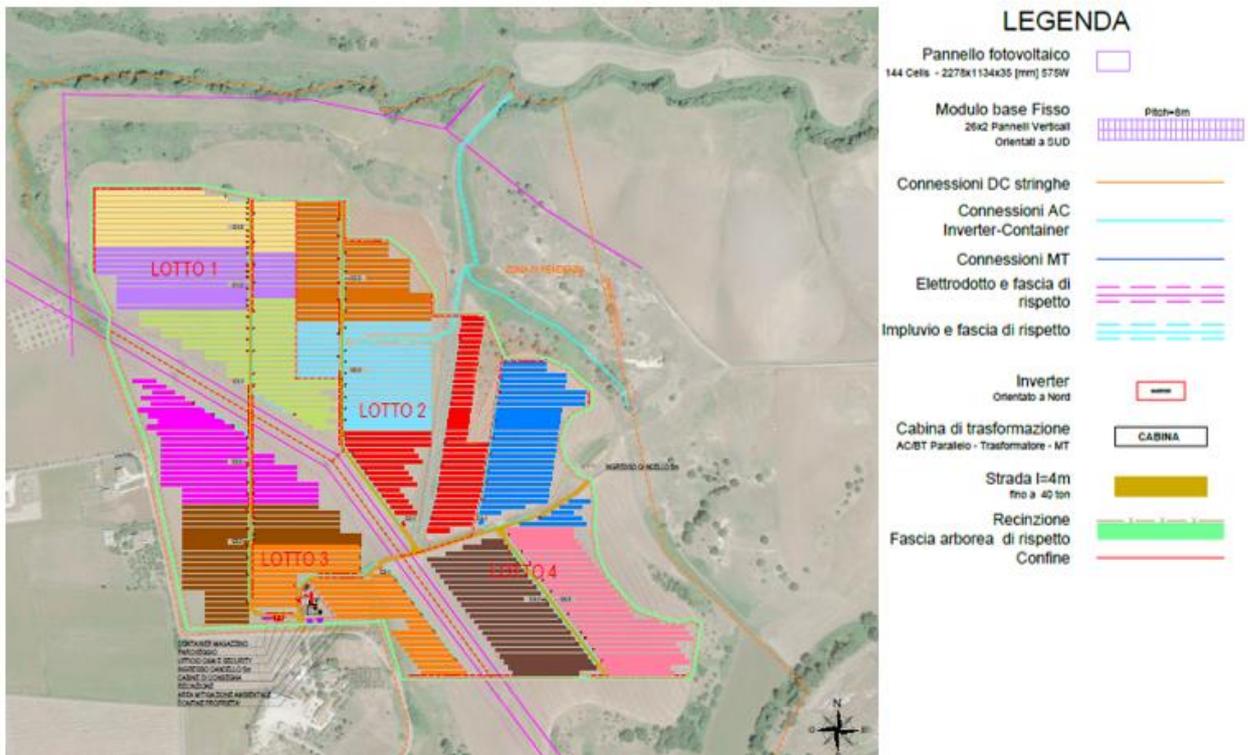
Layout impianto fotovoltaico su ortofoto
